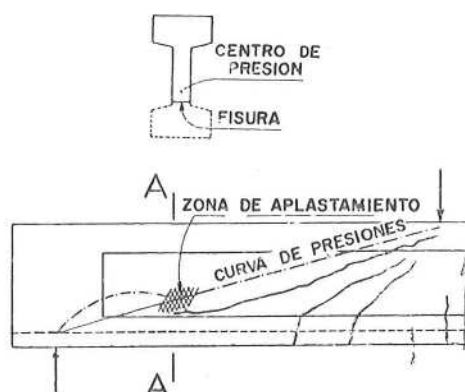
Fisuración y colapso por compresión oblicua en el alma (Sozen)
